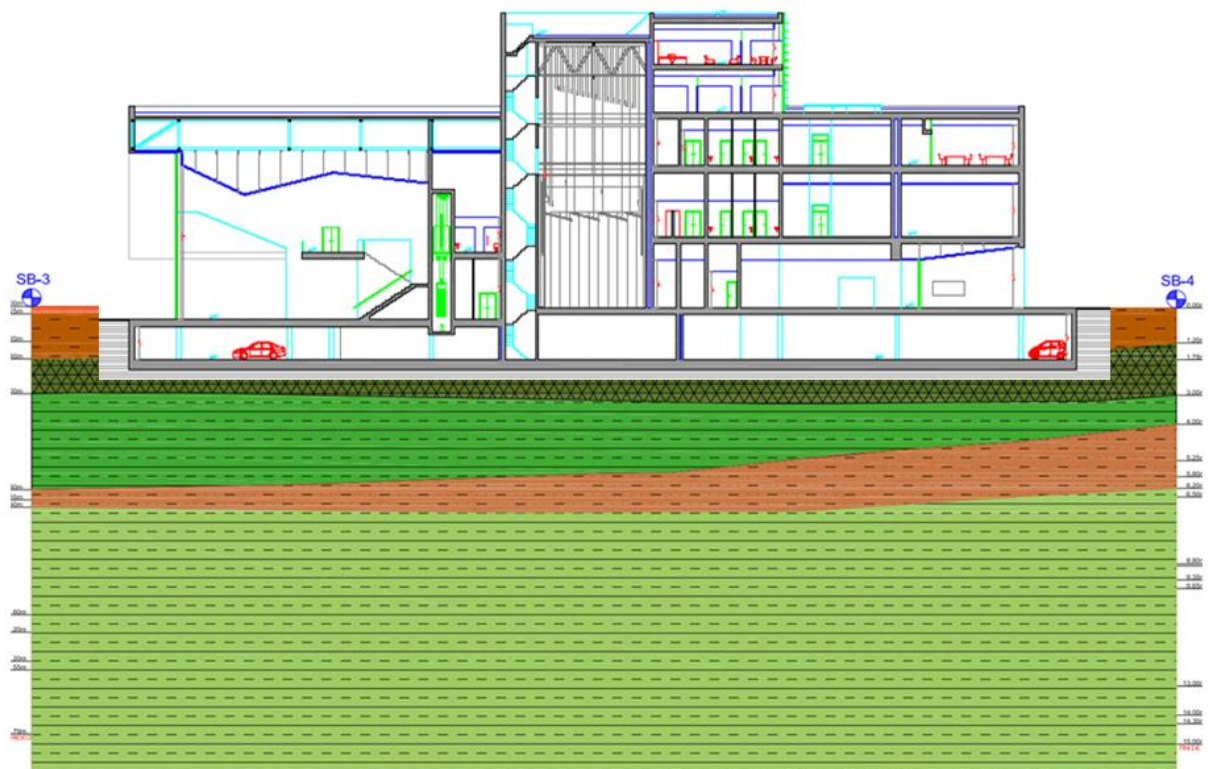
Perfil geológico-geotécnico I-I' con el edificio.
